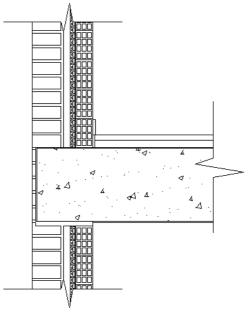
Encuentro de fachada con forjado, caravista. Fuente: Edición propia
